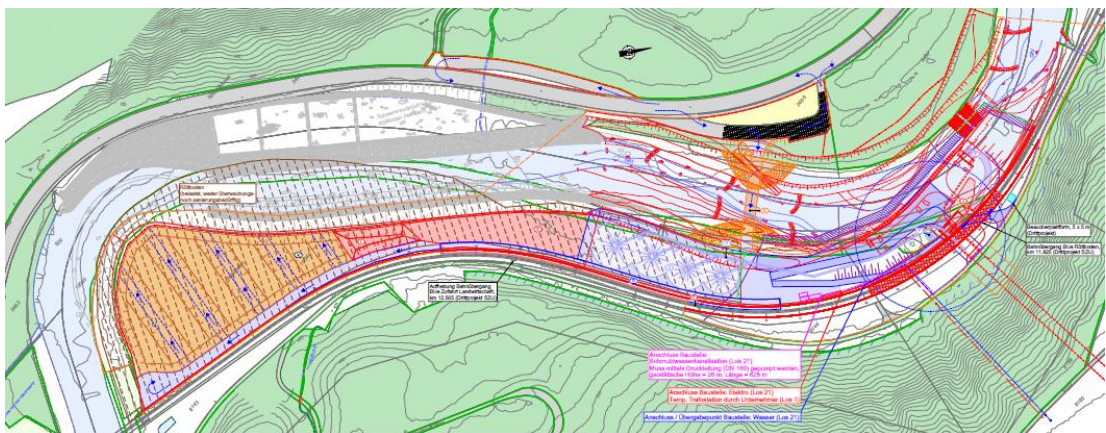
Planausschnitt «Einlaufbauwerk, Sihl Materialbewirtschaftung, Installation» Plan-Nr. 41-119
